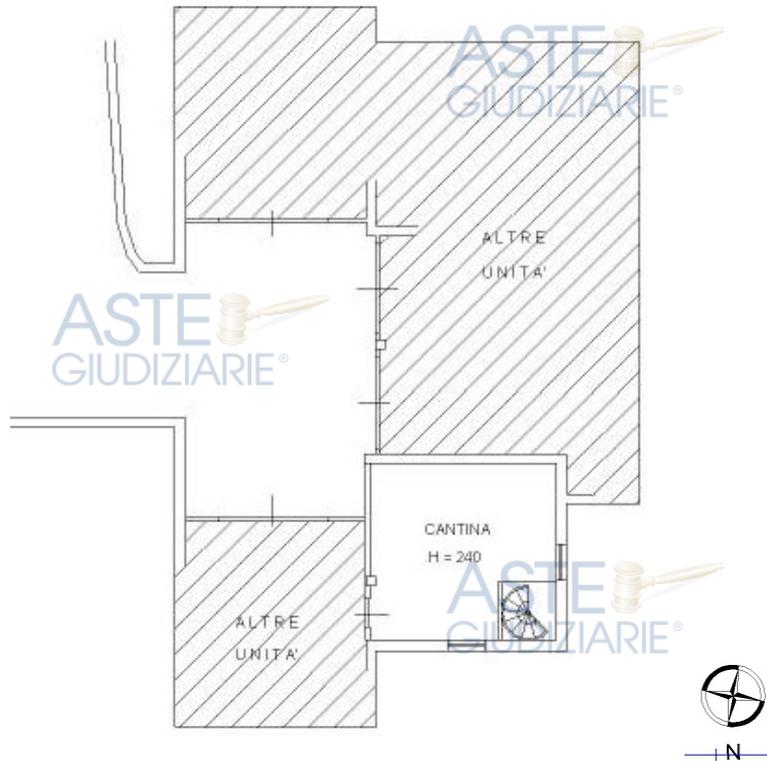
Stralcio planimetria appartamento – NCT Fg.4 particella 370 sub. 1
